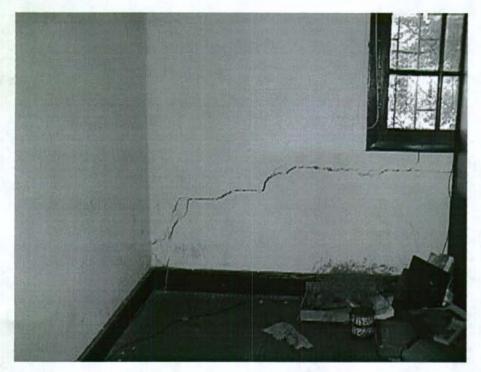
Agrietamiento de muros de segundo piso, vista interna.
